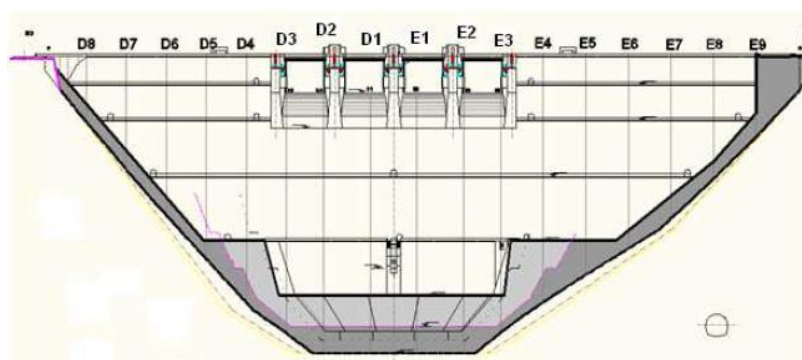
Alçado de jusante da estrutura da barragem (Ferreira, 2010)
